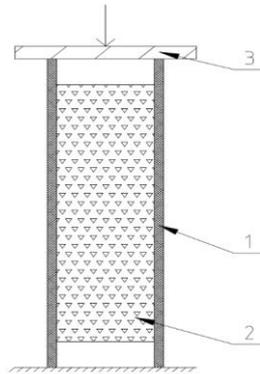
Схема нагружения образцов 1-9. 1 – Фибролит, 2 – Полипропилен, 3 – металлическая пластина для передачи усилий на образец.
